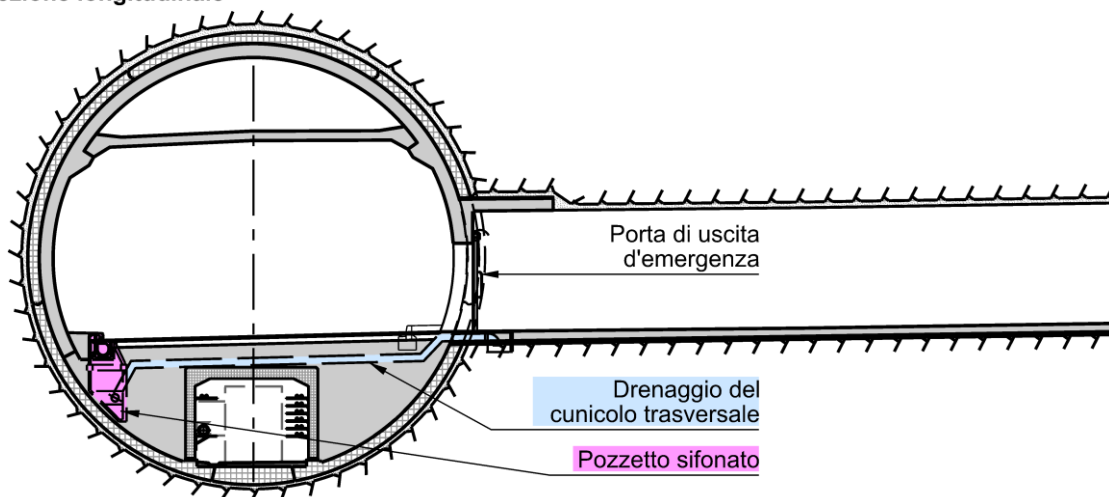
Sezione longitudinale di un cunicolo trasversale pedonale
